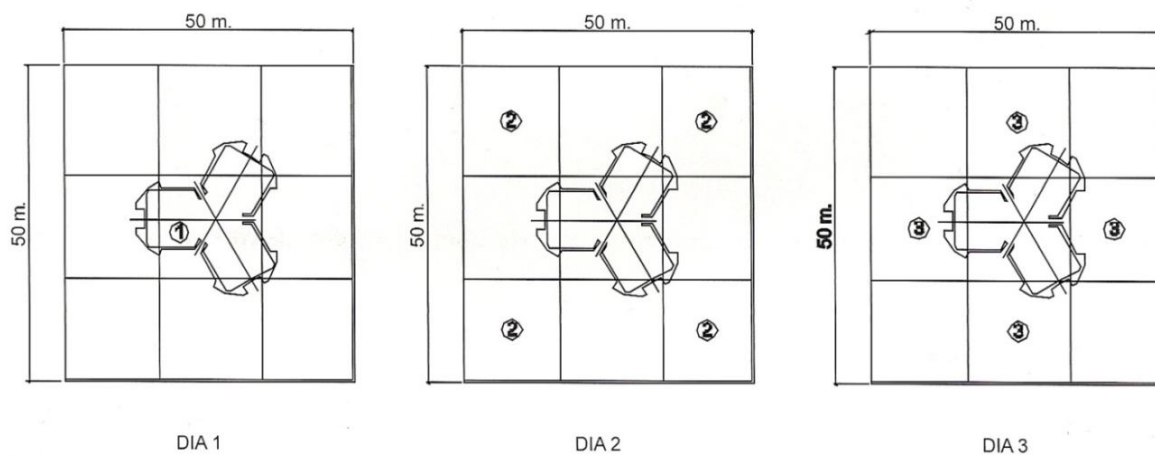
Fases de betonagem da laje de fundação da Torre Sacyr-Vallehermoso (Cálzon; Navarro, 2008)
